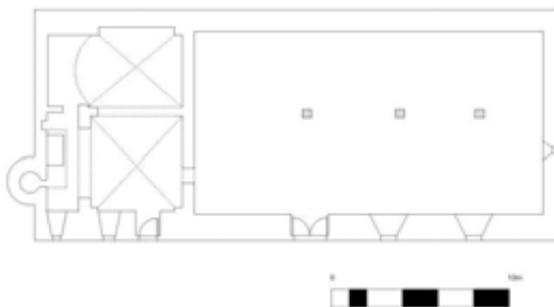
Plan d'une *crota-palhissa*, d'après le plan de la ferme de la Besse, Usclades-et-Rieutord (07)
